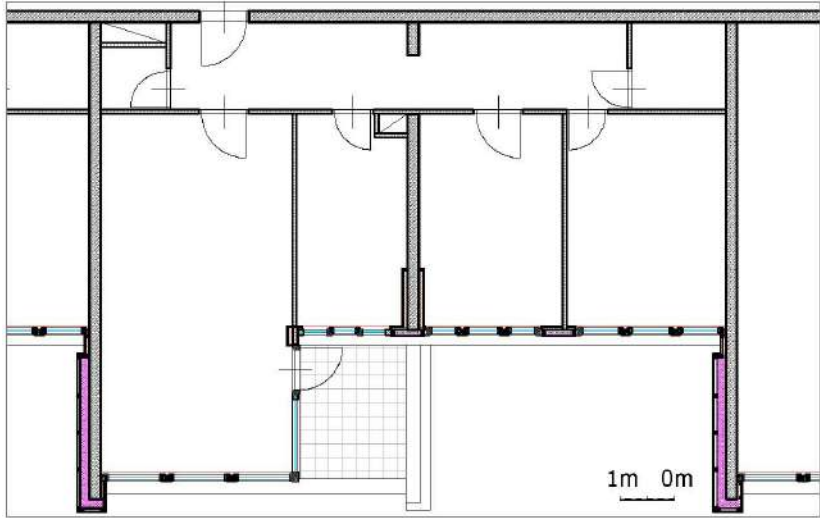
Grundriss Regelwohnung Varianten, RfM Architektur
